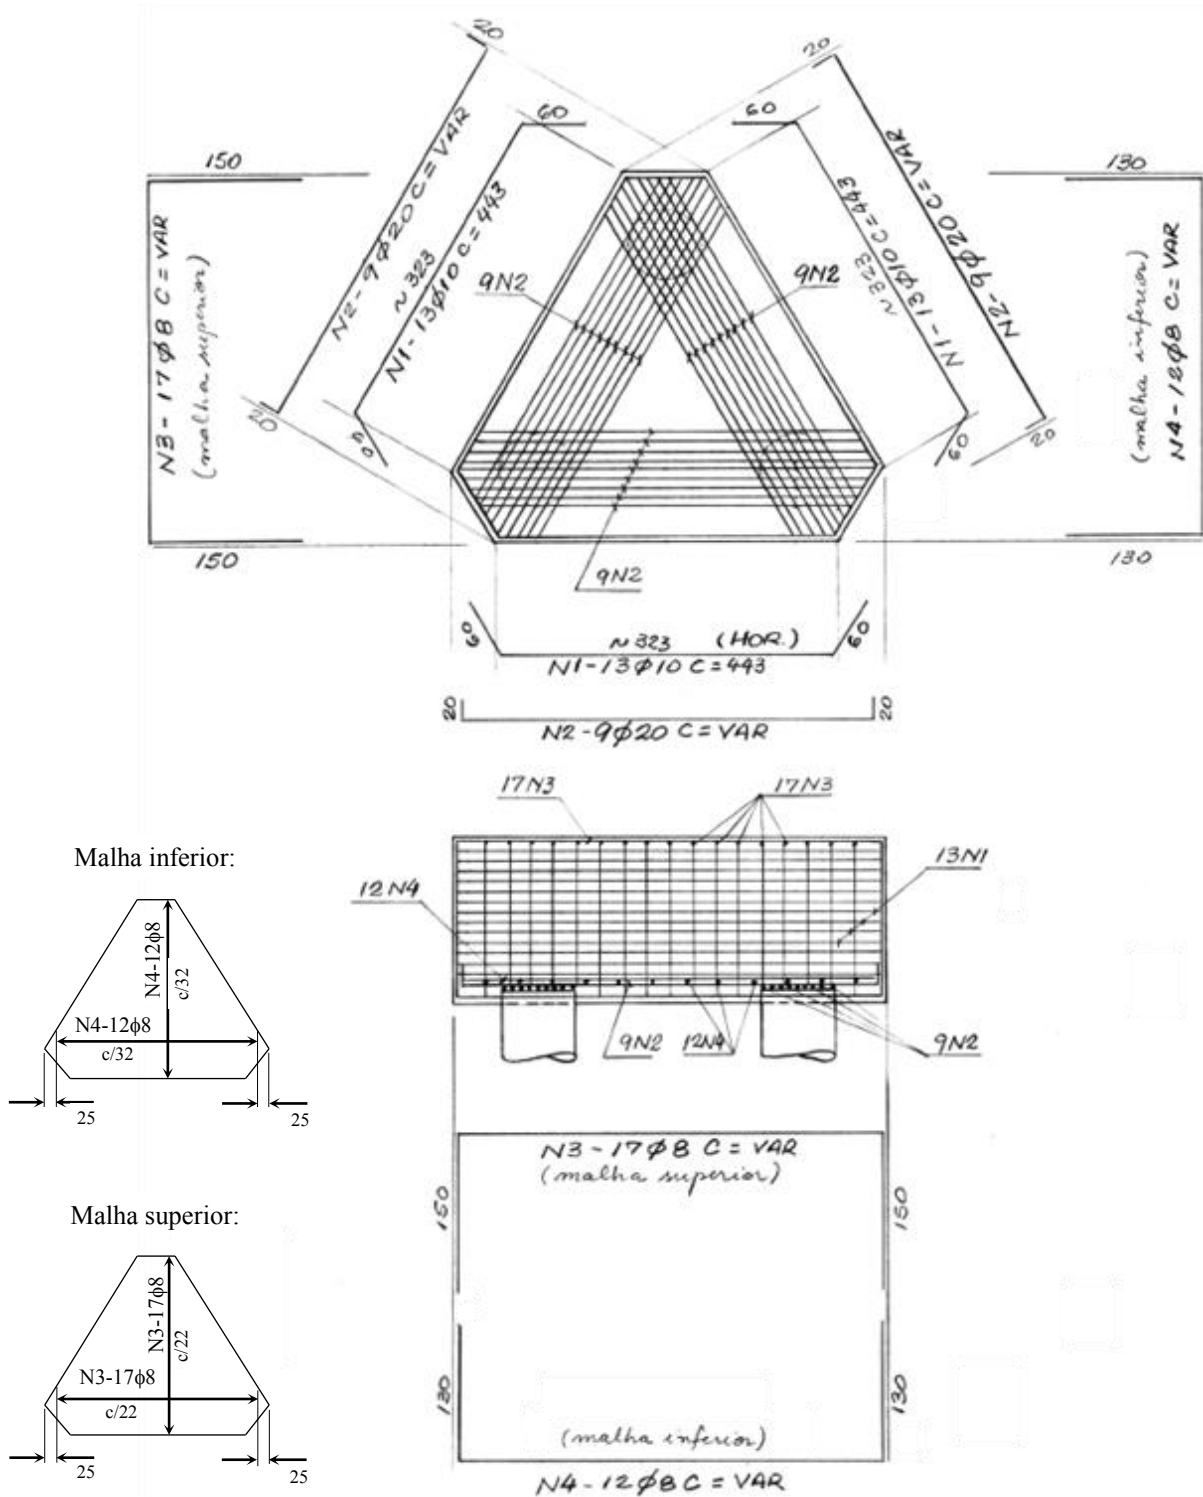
Detalhamento das armaduras do bloco sobre três fustes de tubulão.
